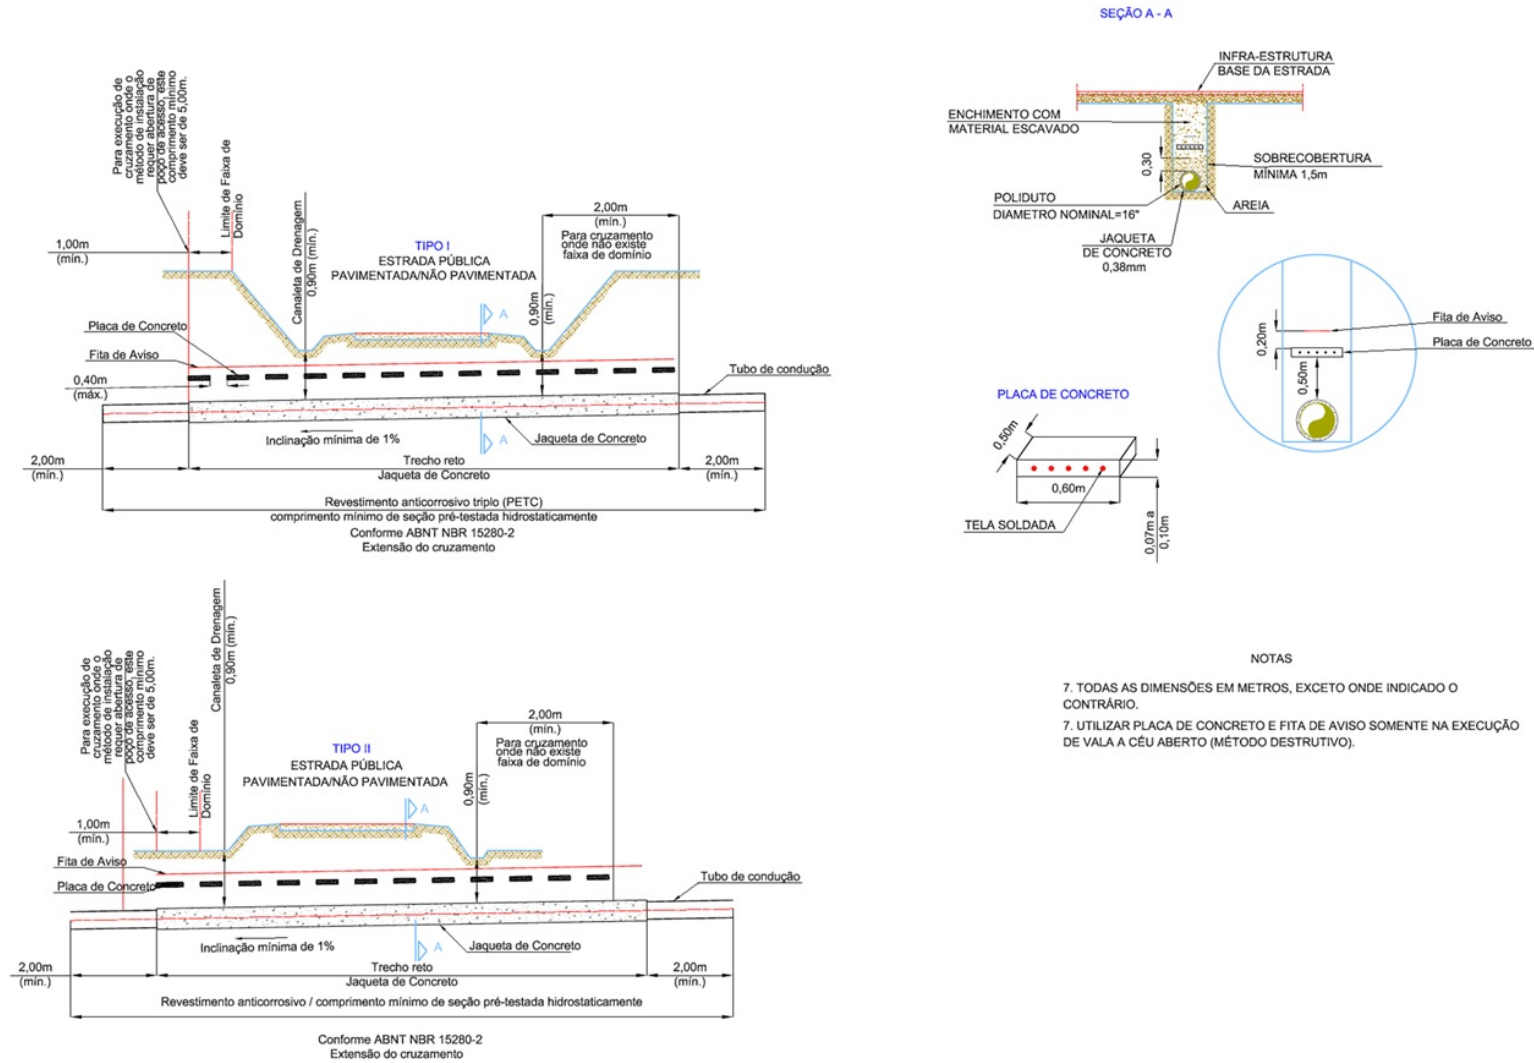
Detalhe Típico Cruzamento – Estrada Pavimentada / Não Pavimentada.
